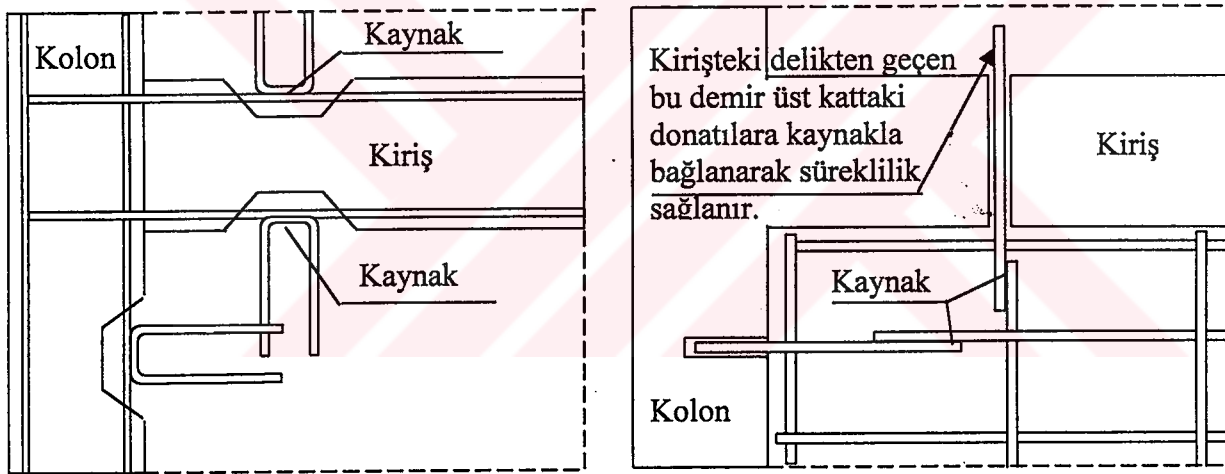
Eklenen perdenin donatısının mevcut kolon ve kirişe bağlanması
